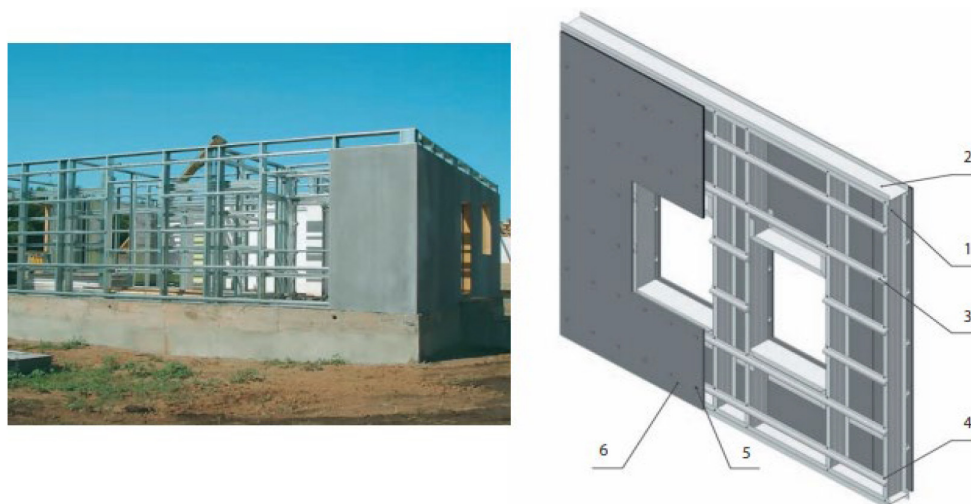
Несъемная опалубка из хризотилцементных листов на металлическом каркасе
